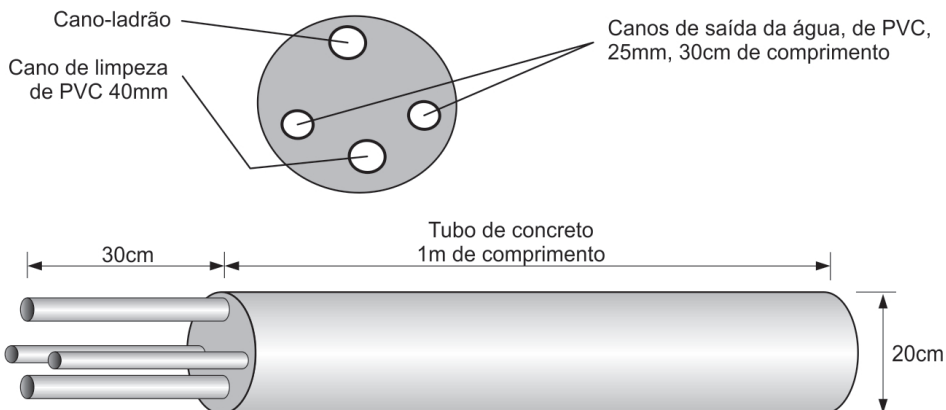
Layout de construção da estrutura física utilizando tubo de concreto e canos menores de PVC
